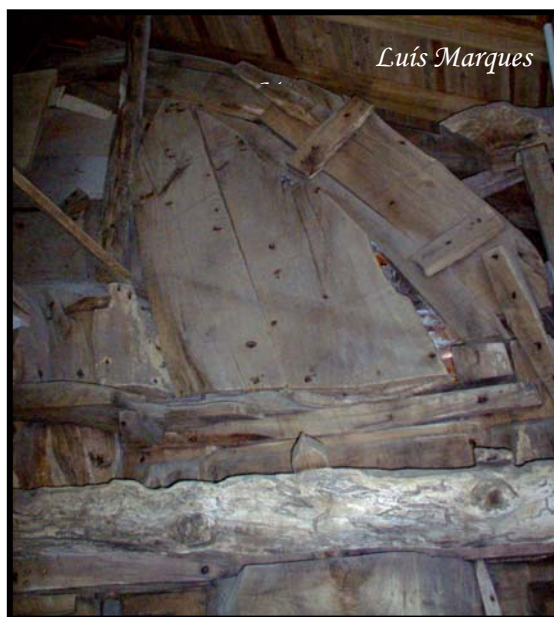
Pormenor do escurecimento da madeira provocado pela oxidação de metais
